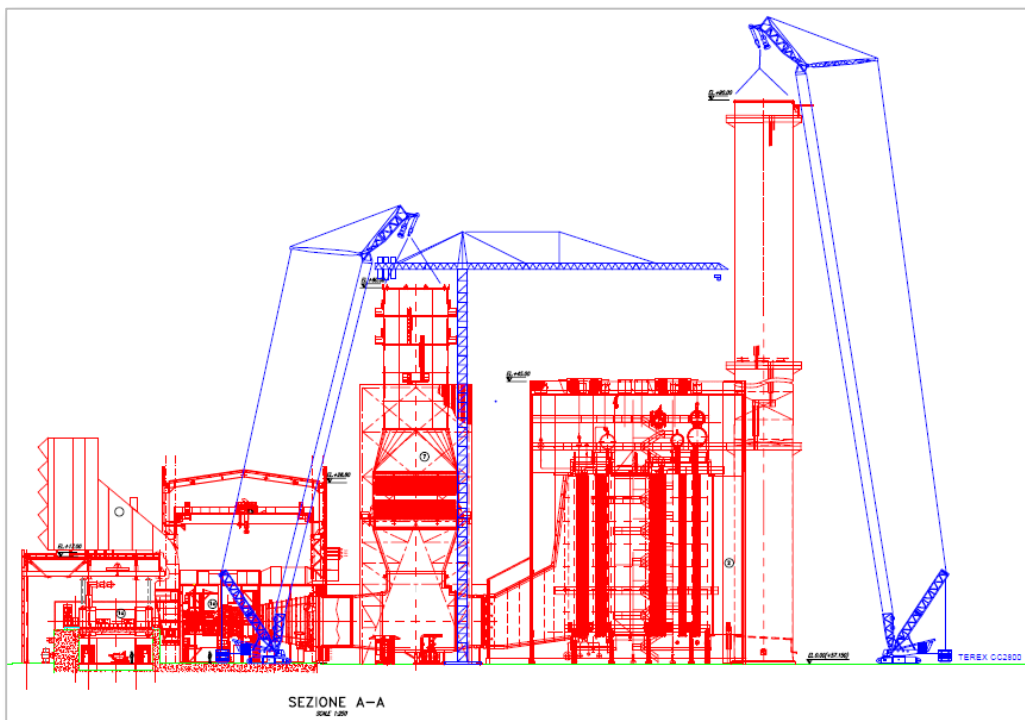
Sezione tipo mezzi di sollevamento
